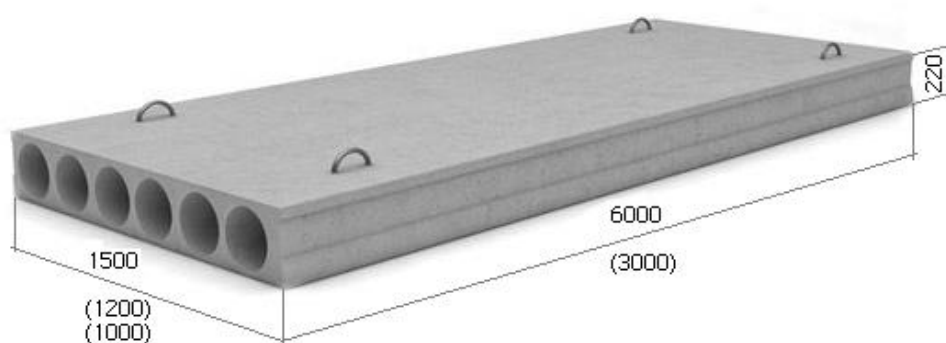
Залізобетонна багатопустотна плита перекриття / покриття
